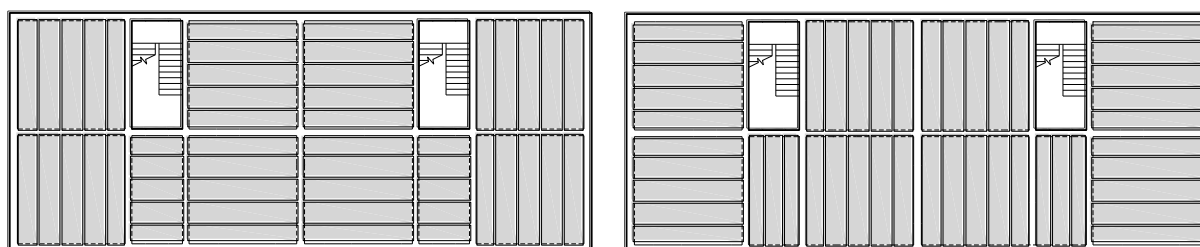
Примеры конструктивных мероприятий повышающих жесткости сборных железобетонных перекрытий или покрытий
